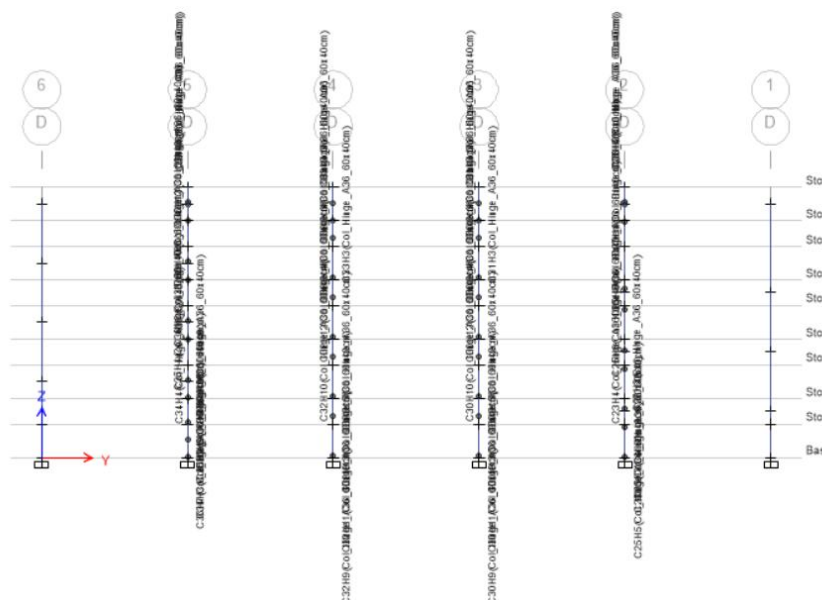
Columnas del eje D encamisadas con Hinges.
